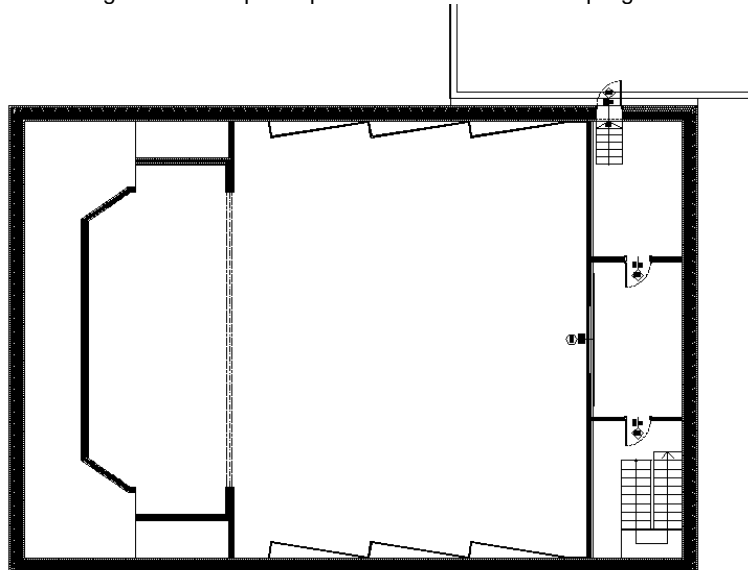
Pianta piano secondo scuola: stato di progetto
